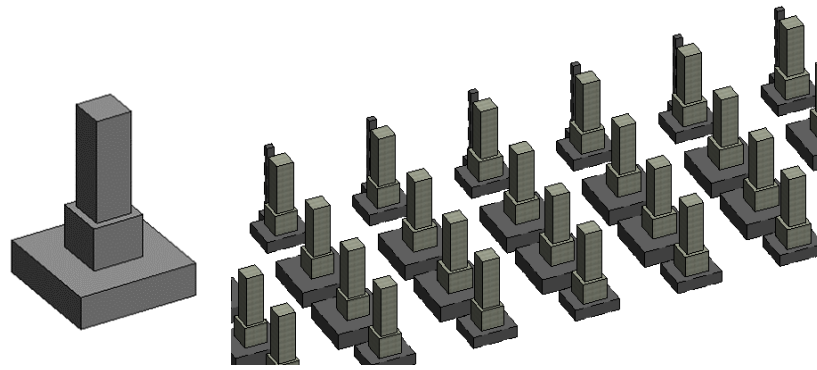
Reforzamiento de las columnas y ensanche de la parte inferior (HERM-Revit)
